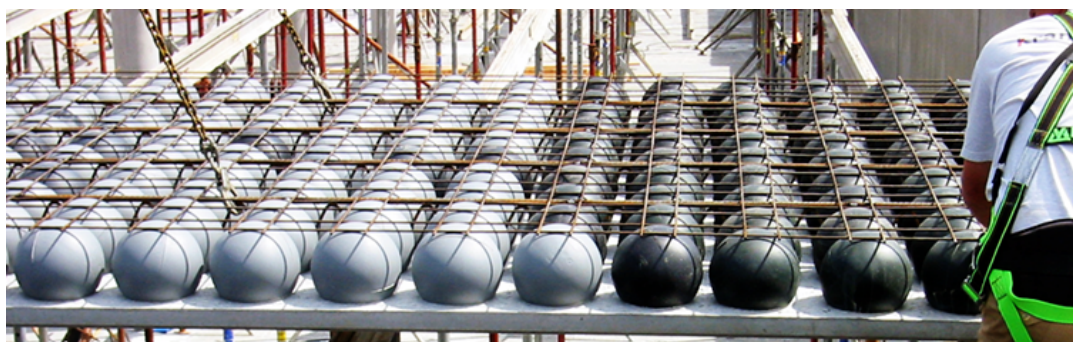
Laje tipo *Bubbledeck* com pré-laje, *Bubbledeck Brasil* (2016)
